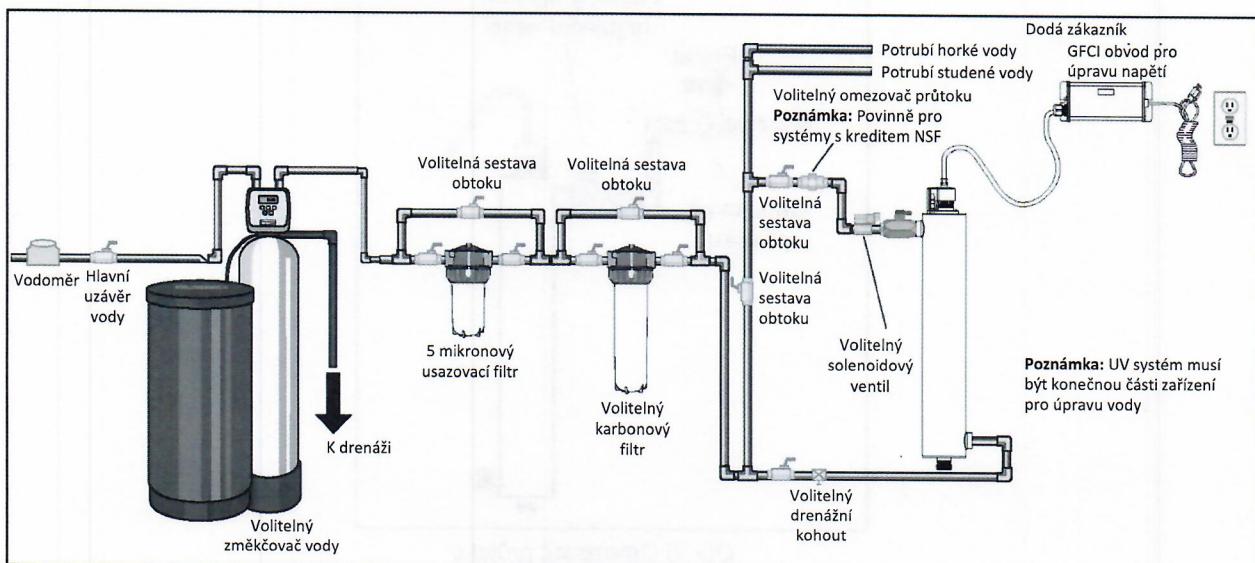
Instalace UV lampy - Svislá a vodorovná
